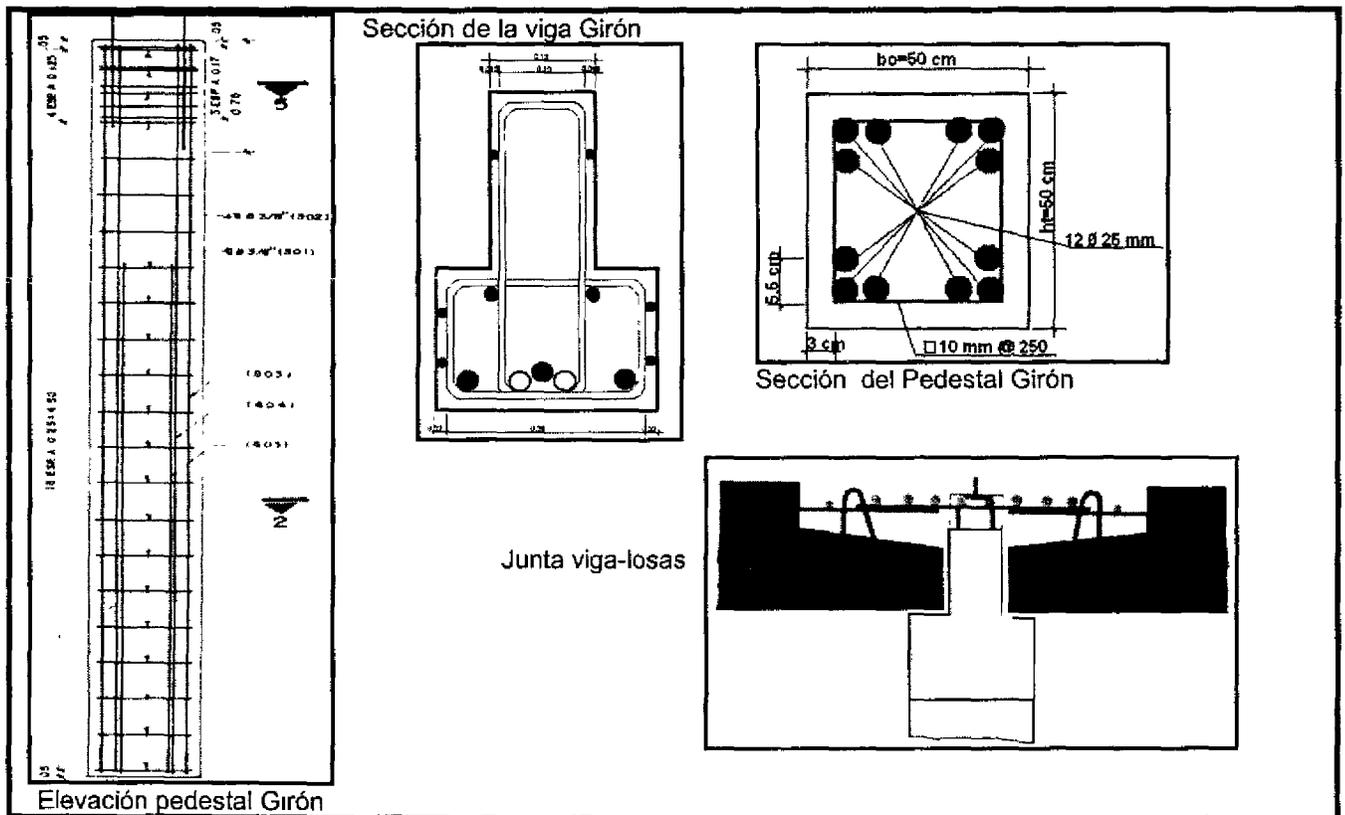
Detallado de elementos estructurales del Sistema Girón.
